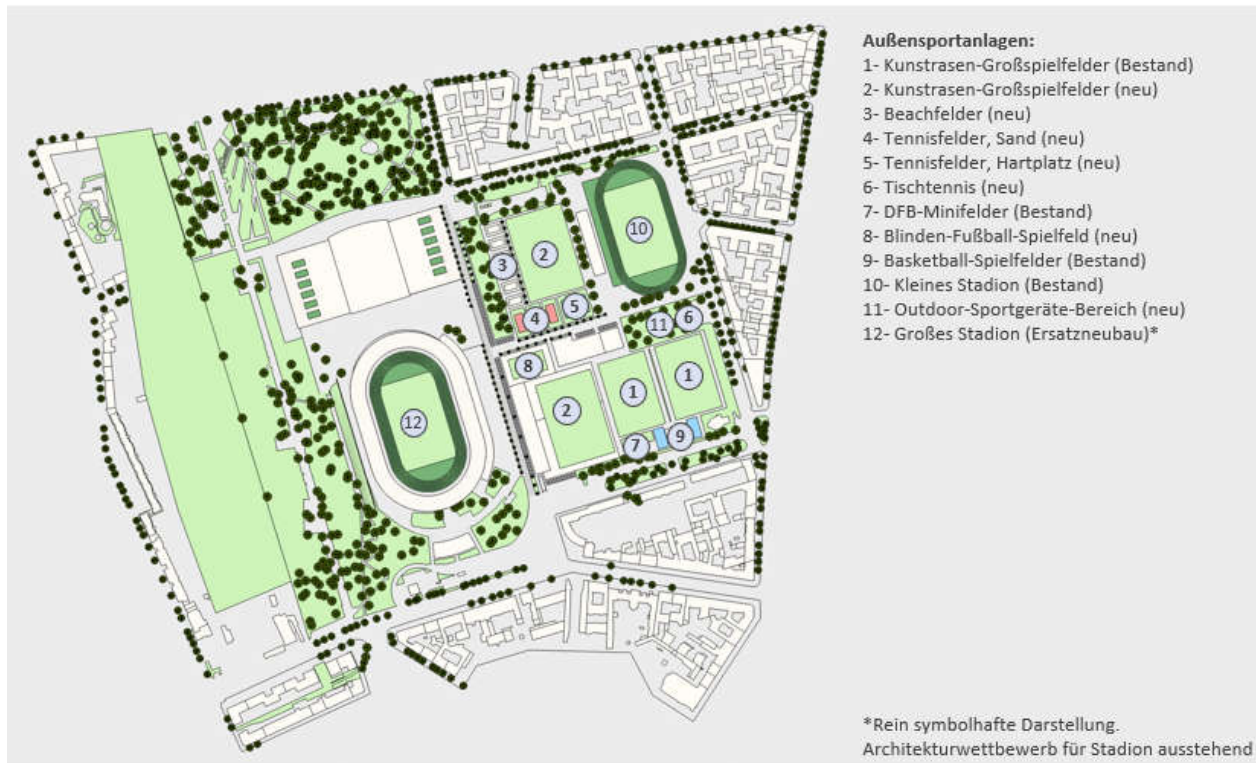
Lageplankonzeption Variante 4 – Außensportanlagen
